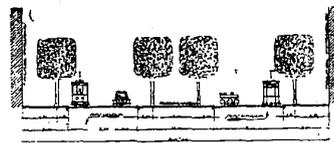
Coupe transversale d'une voie de 40 mètres
